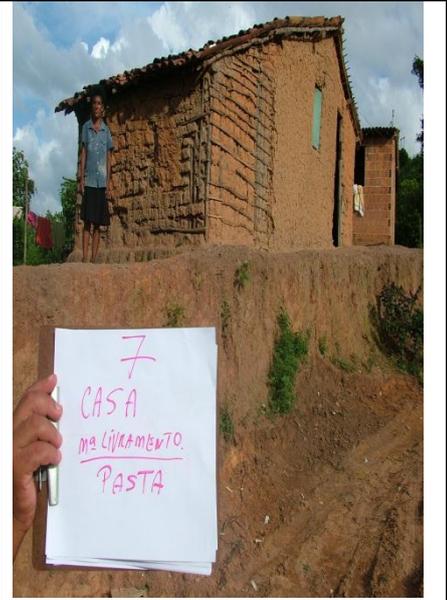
Casa construída por dona Maria do Livramento e sua família, toda revestida de barro.
